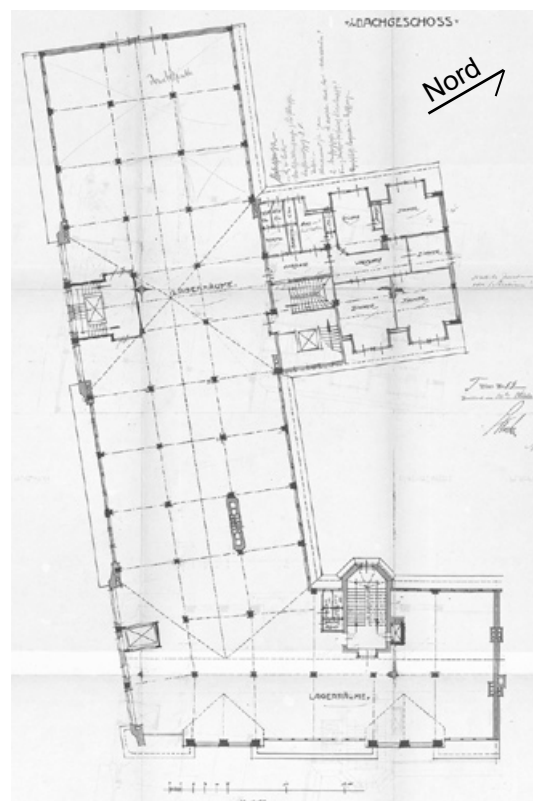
Grundriss Dachgeschoss (StadtAM, DE-1992-LBK-19330).
